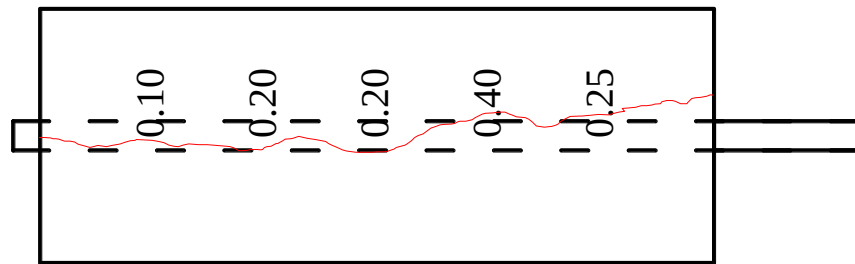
電食後ひび割れ発生状況およびひび割れ幅（丸鋼供試体）
